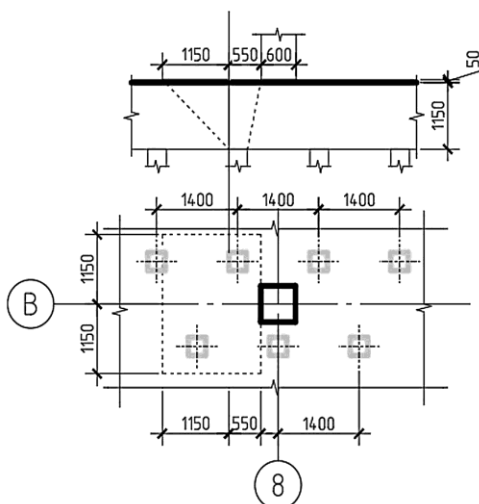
Схема до розрахунку плитного фундаменту на продавлювання
